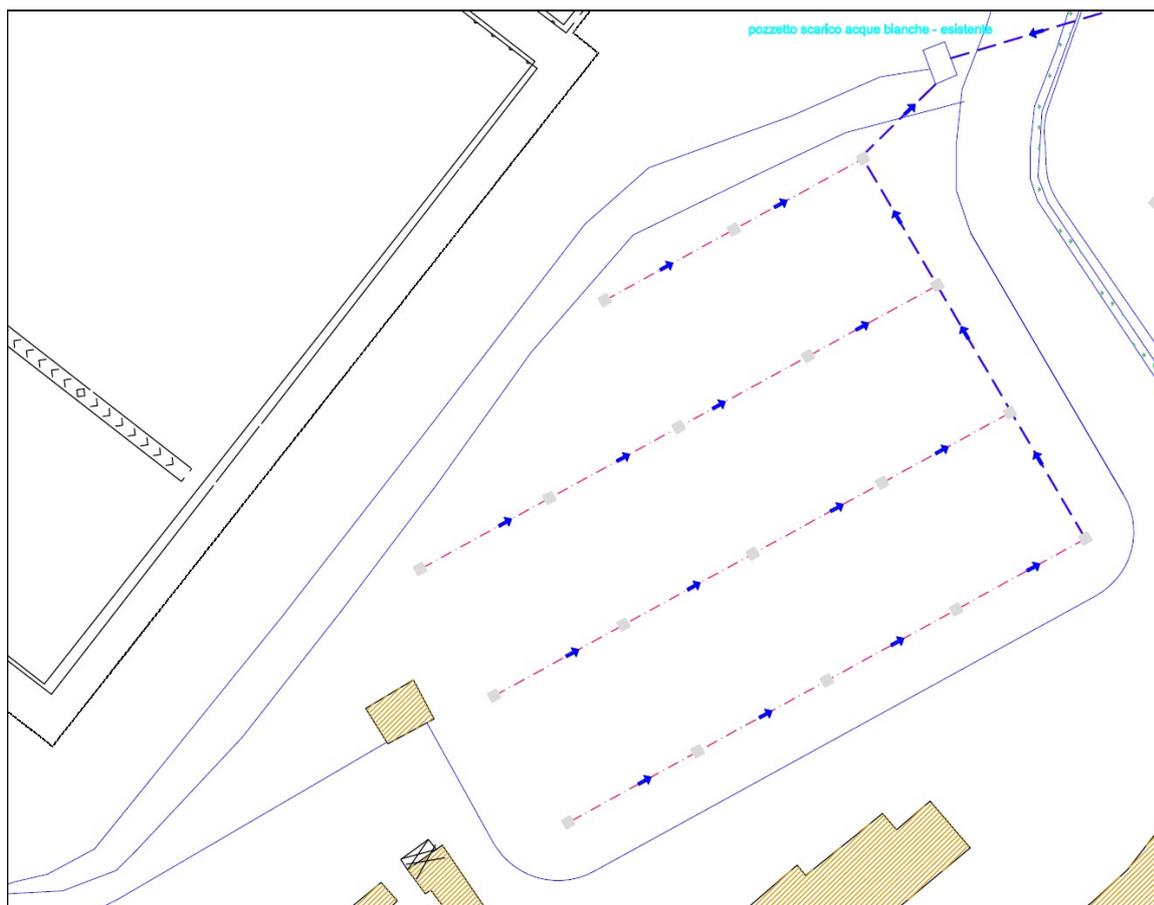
Planimetria dell'area barche con la rappresentazione delle opere in progetto
